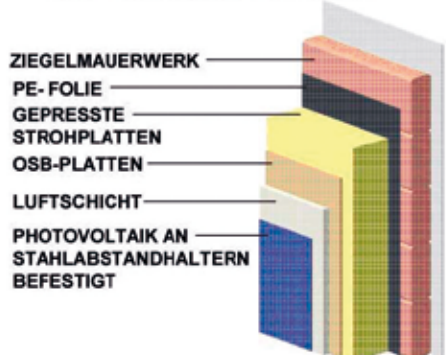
Wandaufbau der Photovoltaikfassade. Grafik: ATB-Becker
